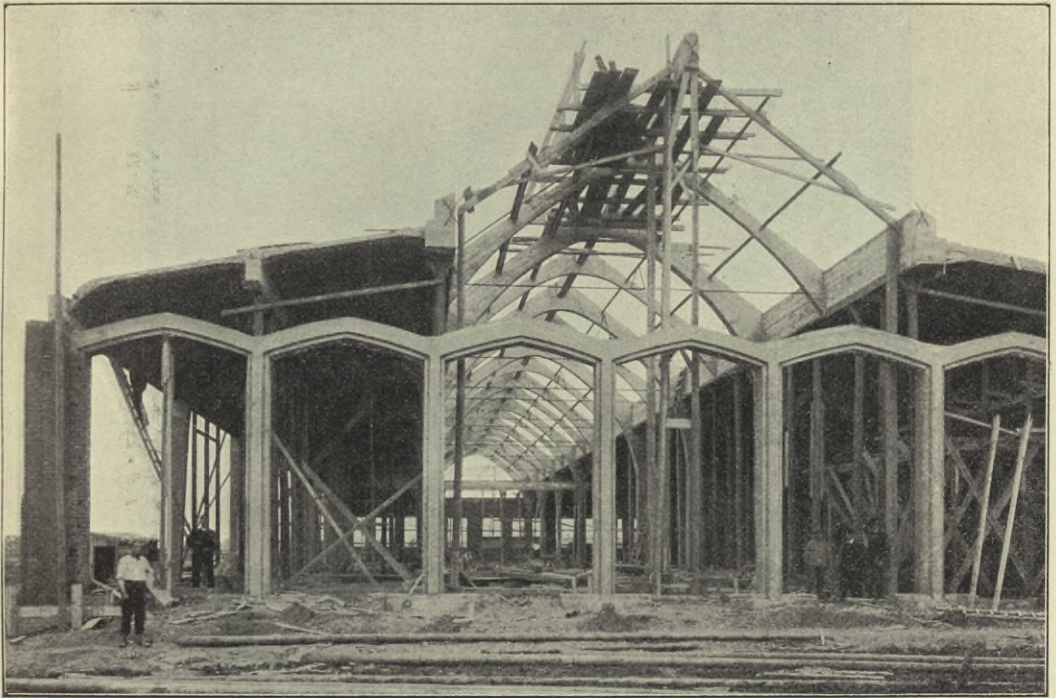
Straßenbahnwagenhalle in Düsseldorf
